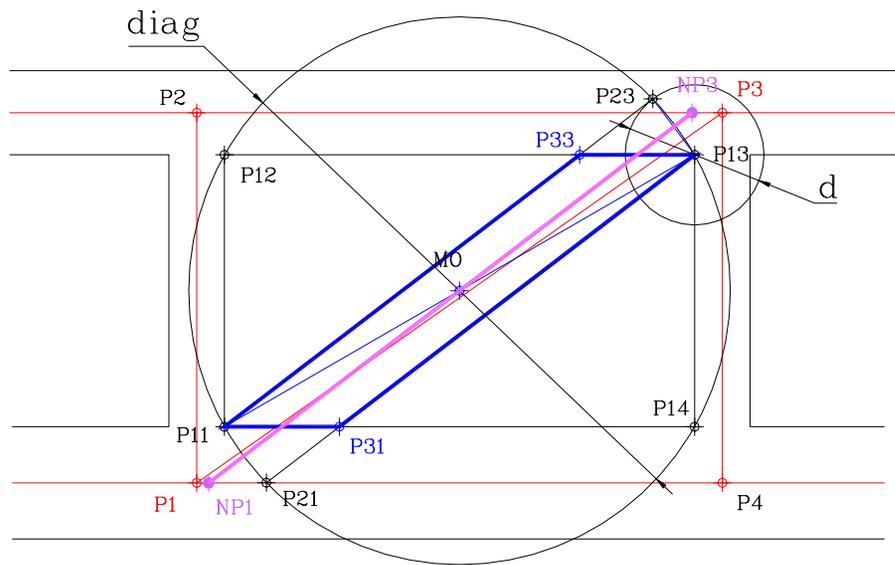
Modification d'un segment en fonction d'un assemblage désiré qui tient compte de la largeur des pièces.
